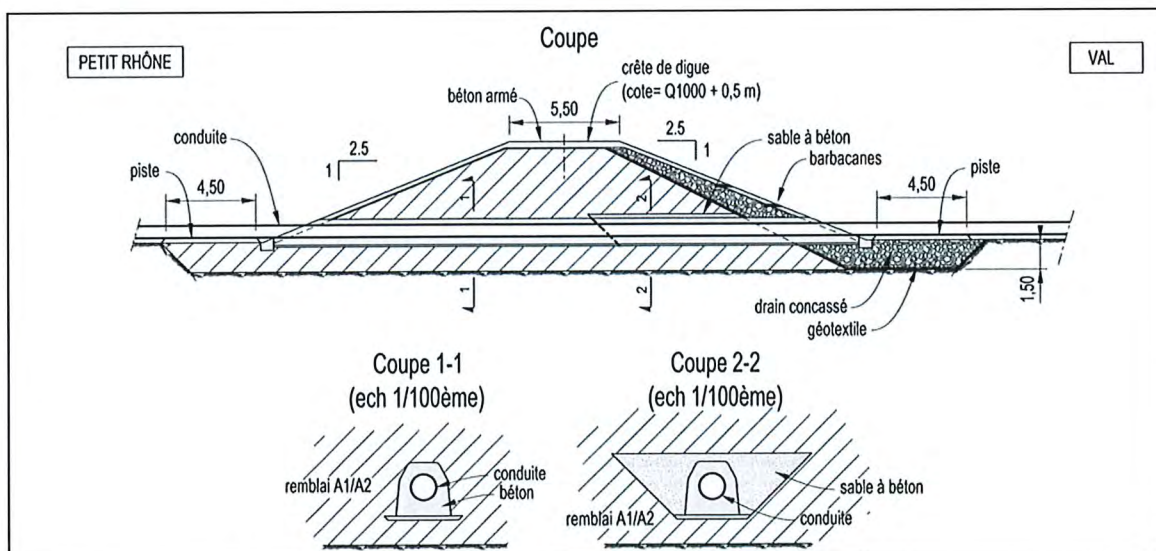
LOT 2 – Schéma de principe – Ouvrage traversant en gravitaire
